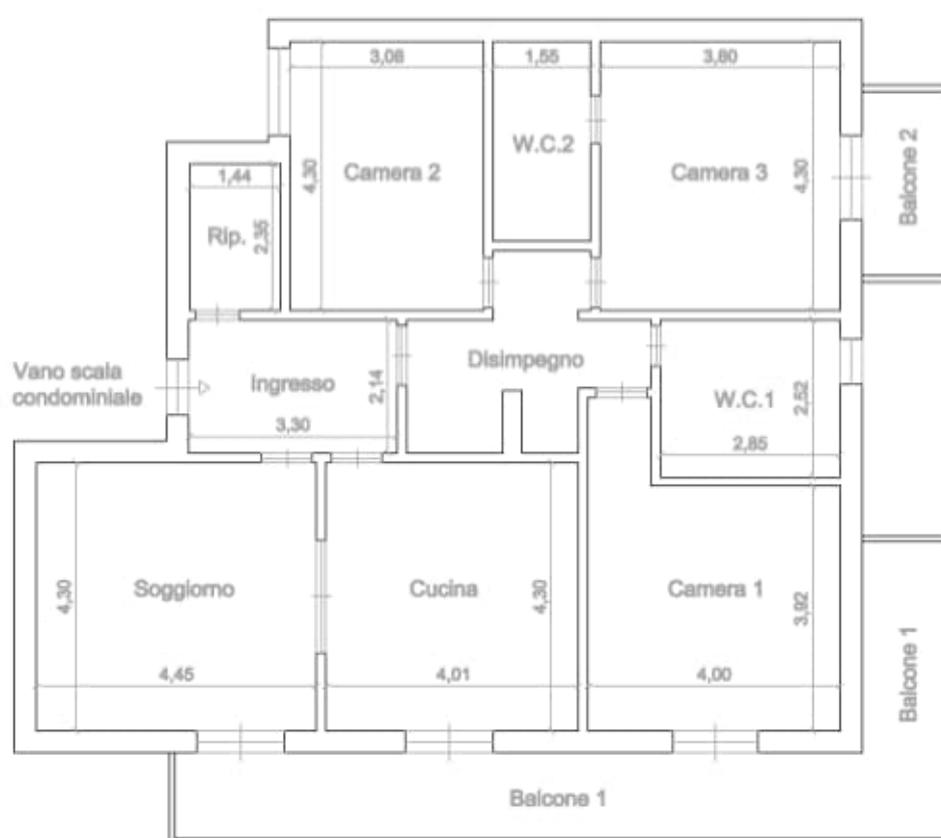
Planimetria dell'appartamento oggetto di pignoramento, con individuazione dei locali
